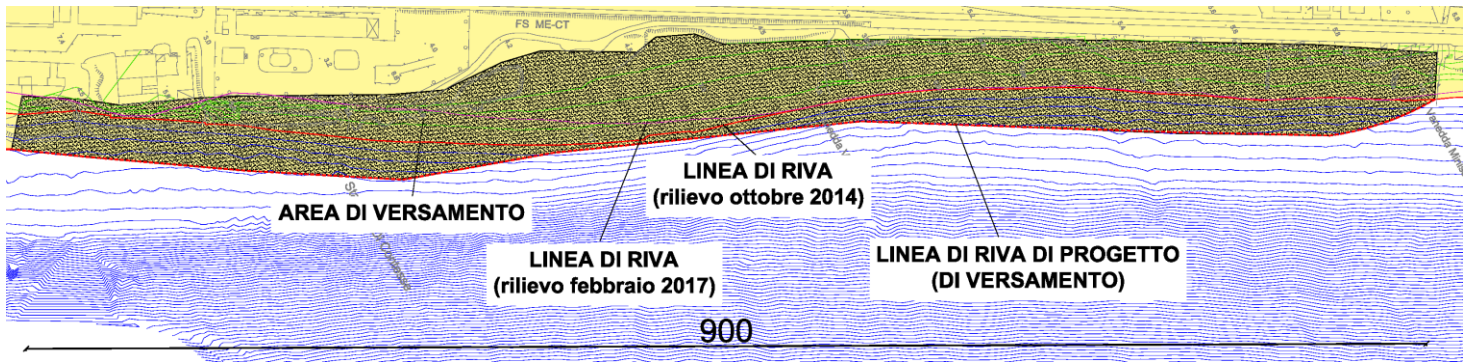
Planimetria ripascimento non protetto – tratto di intervento tra 0 e 600 m dal ripascimento protetto
